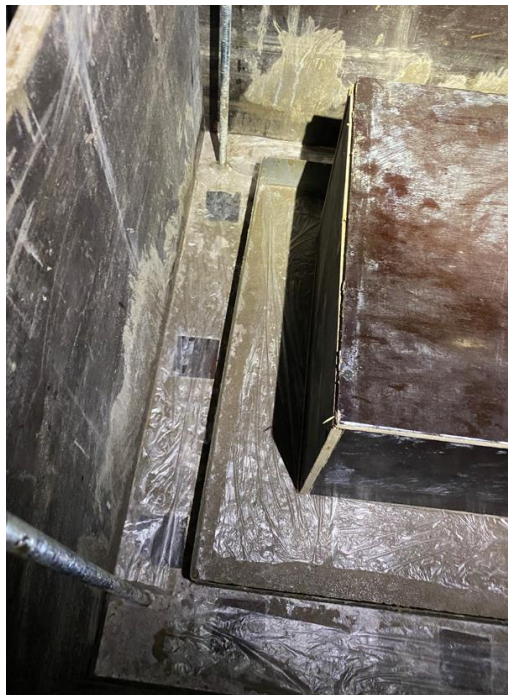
Katsekeha 11 plaadid, kile ja vineerkast tühimiku jaoks [autori erakogu]
